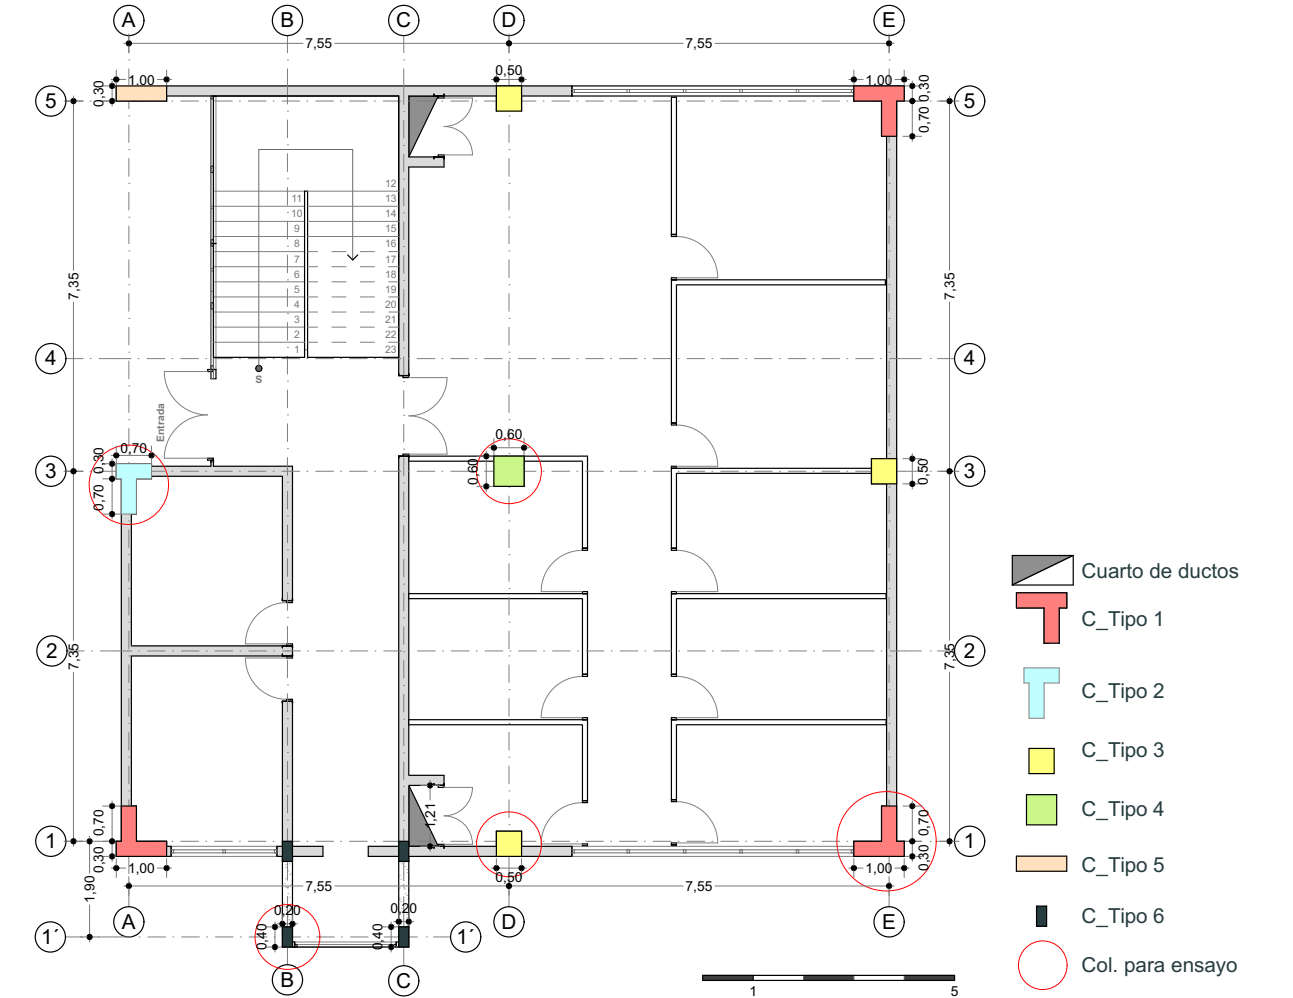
Ubicación de las columnas en planta donde se realizarán los análisis no destructivos.
